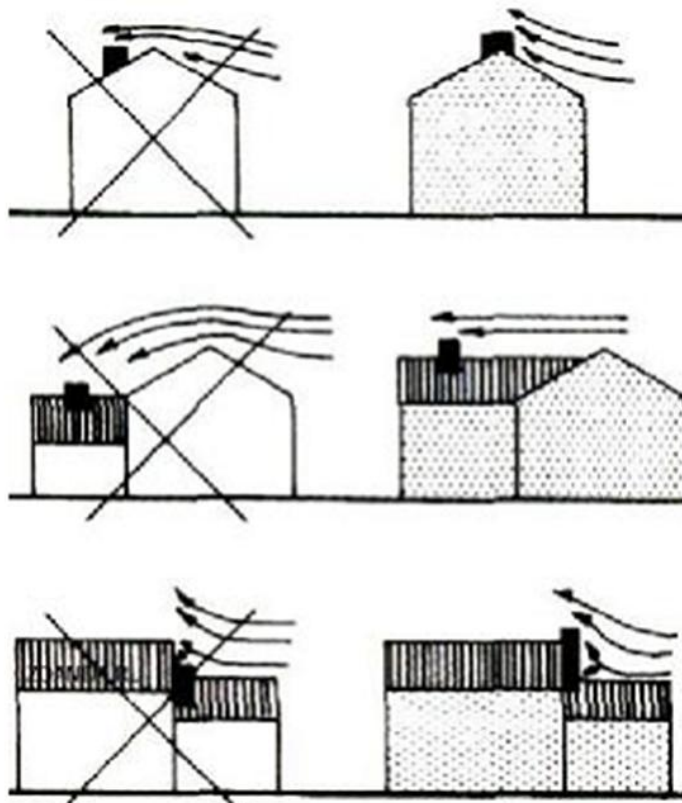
Схемы установки вентиляционных труб на крыше
